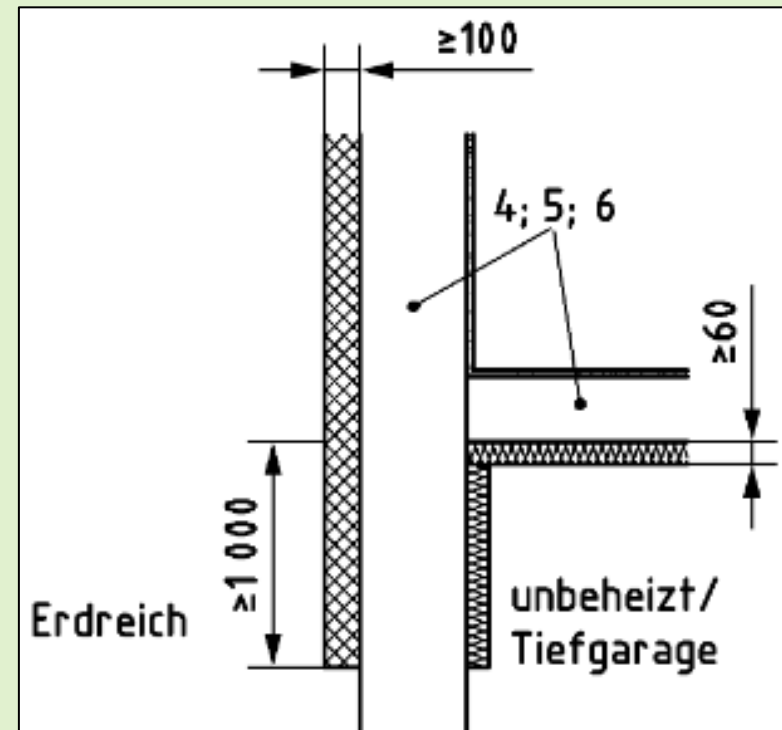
Anschluss Innenwand (24 cm) an Außenwand
